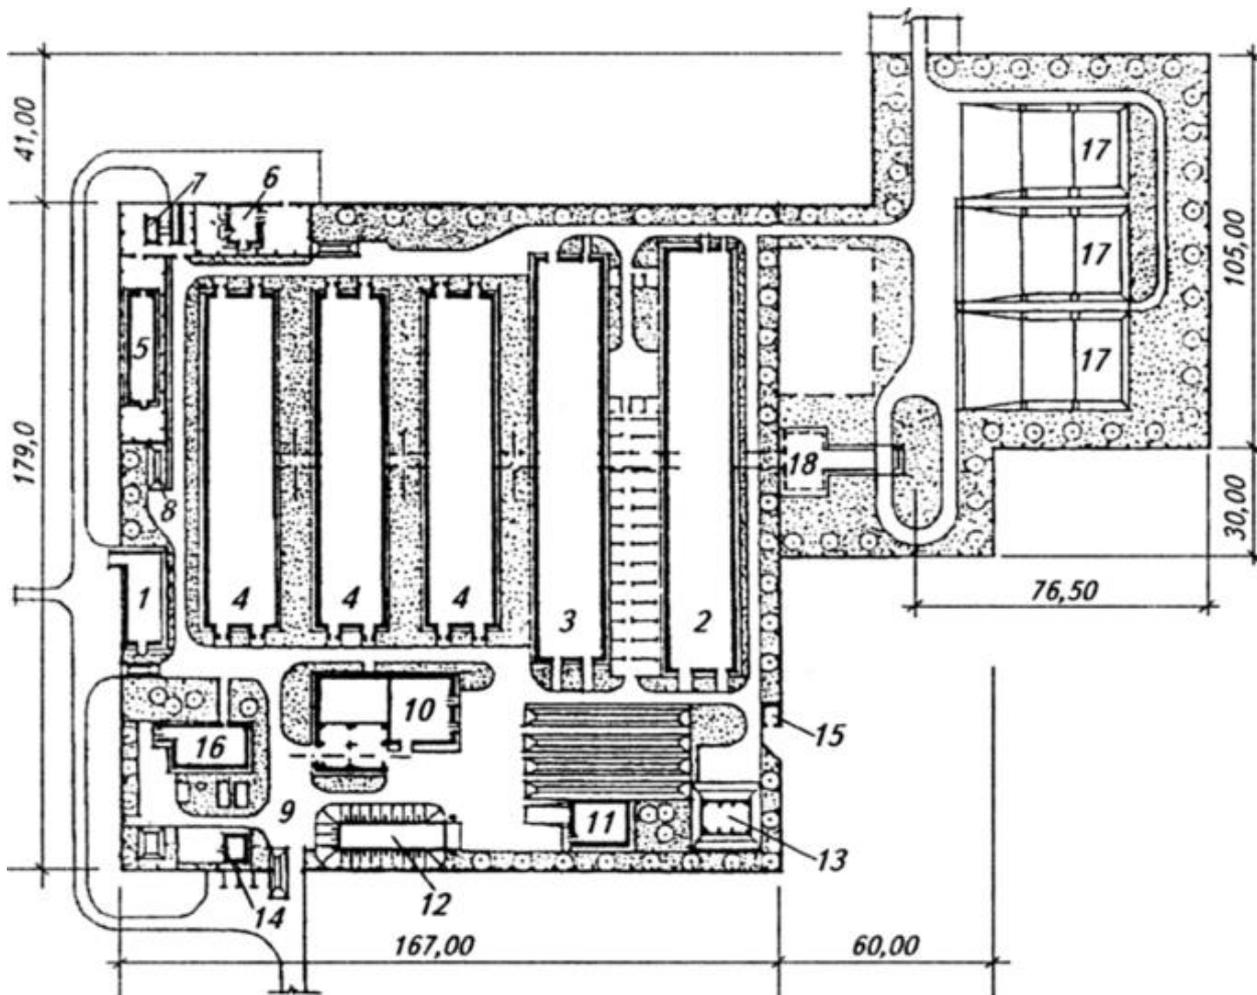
Генеральный план фермы по выращиванию и откорму 6000 свиней в год с кормлением поголовья влажными кормовыми смесями:
